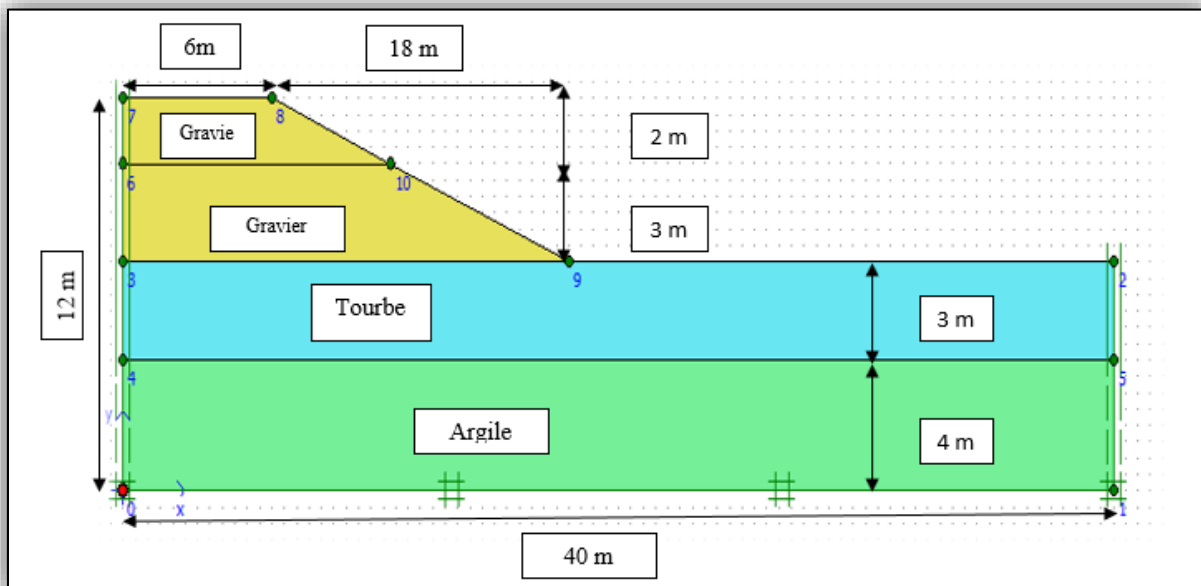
Coupe du model de calcul 1^{er} (Remblais Sans Ballast)
